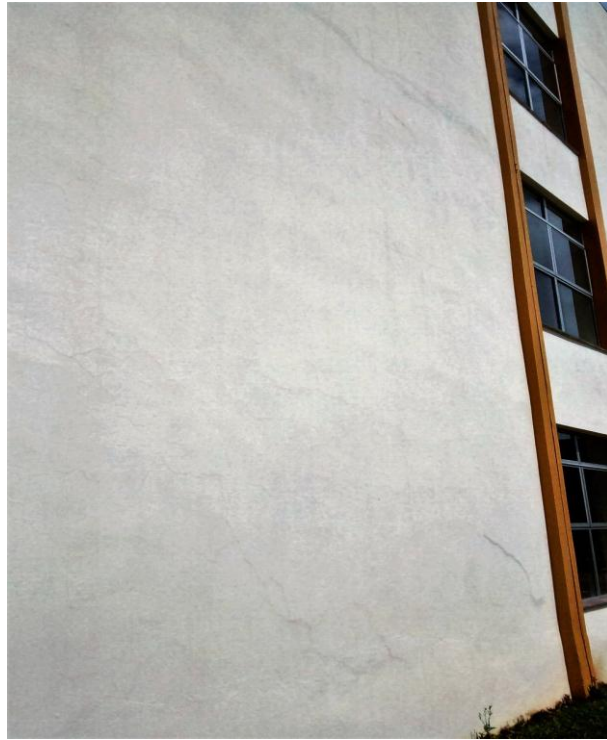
Detalhes das fissuras da fachada leste
